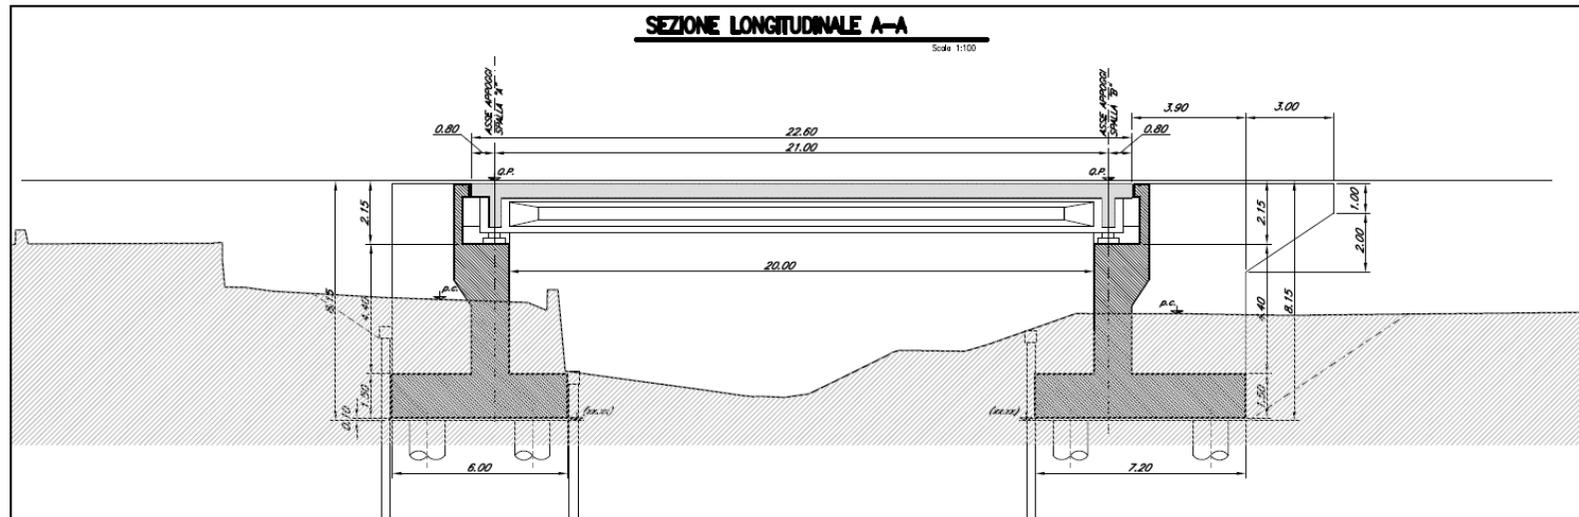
Sezione longitudinale di progetto dell'opera di scavalco
